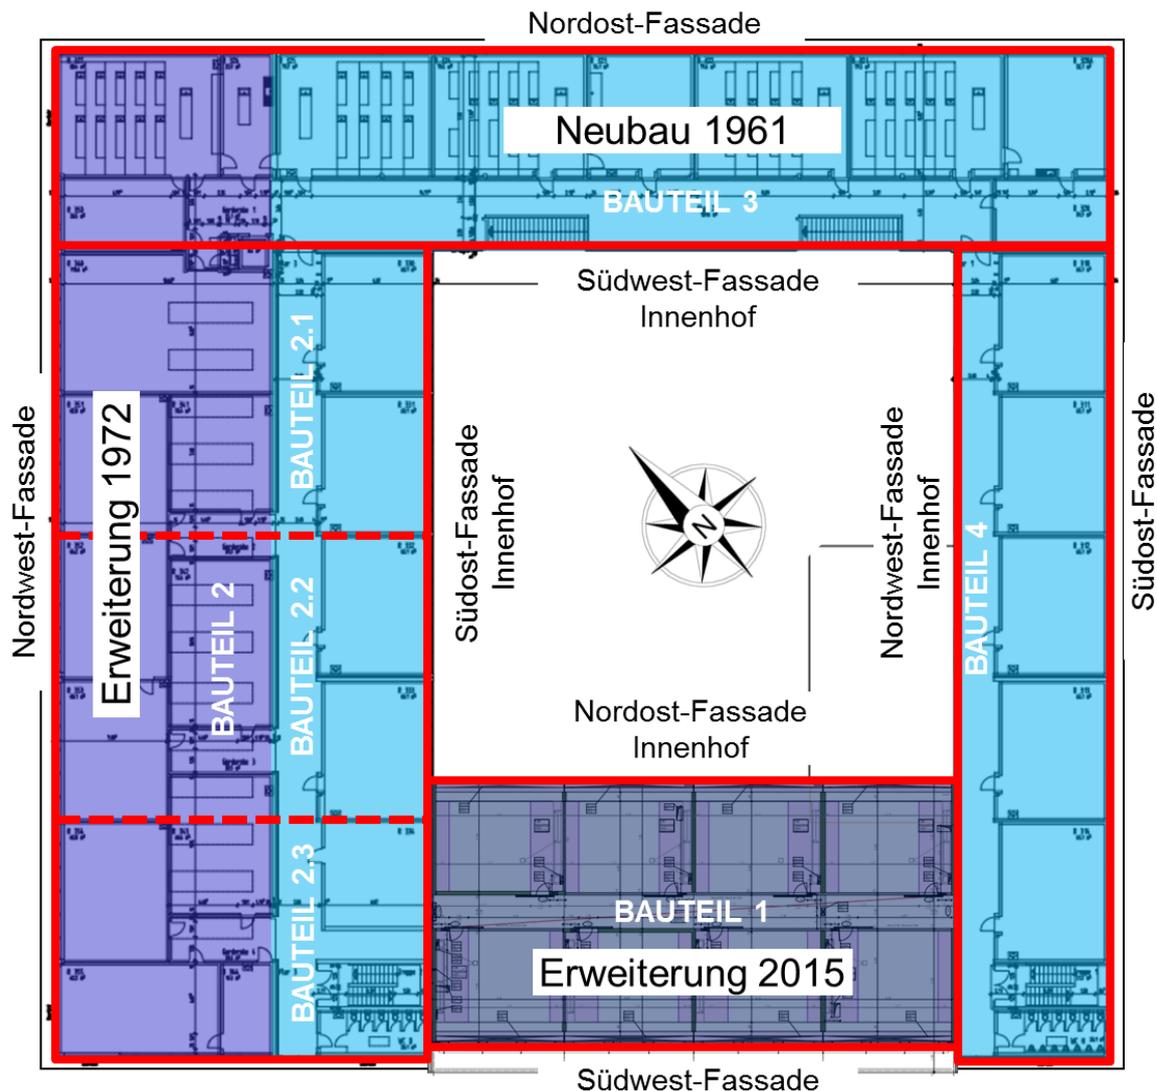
Grundriss des 1. Obergeschosses der Theodor-Heuss-Schule mit Kennzeichnung der Gebäudeteile nach Baualter sowie die im Bericht verwendete Nummerierung der Bauteile
